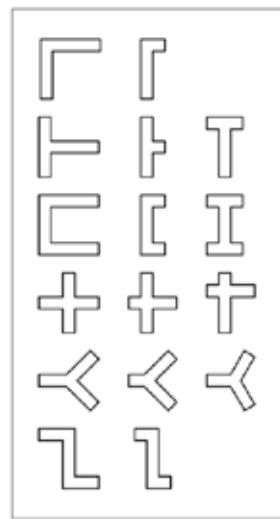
Elementos de muro estabilizados por la forma. Domínguez Grullón, C. S. (2023). Construcción en tapial: hacia una arquitectura del pasado.
